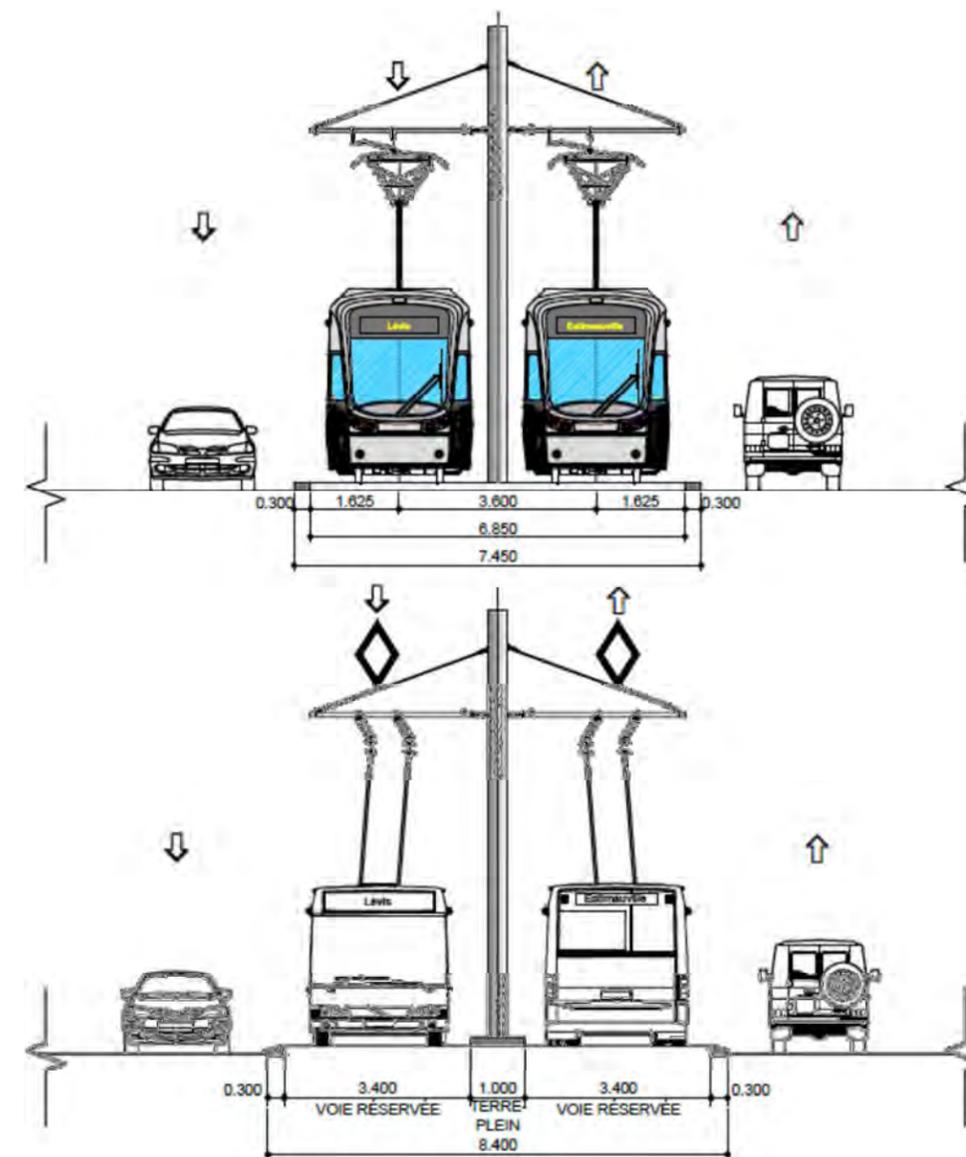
Coupe 10 de 15 - SRB - Site espace restreint - Insertion axiale semi-franchissable
